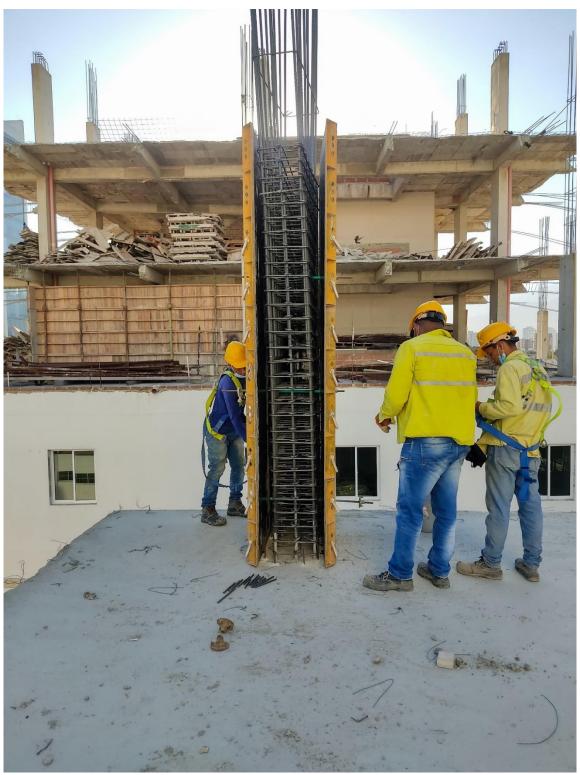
Colocación de traslapos y encofrado de columnas.
